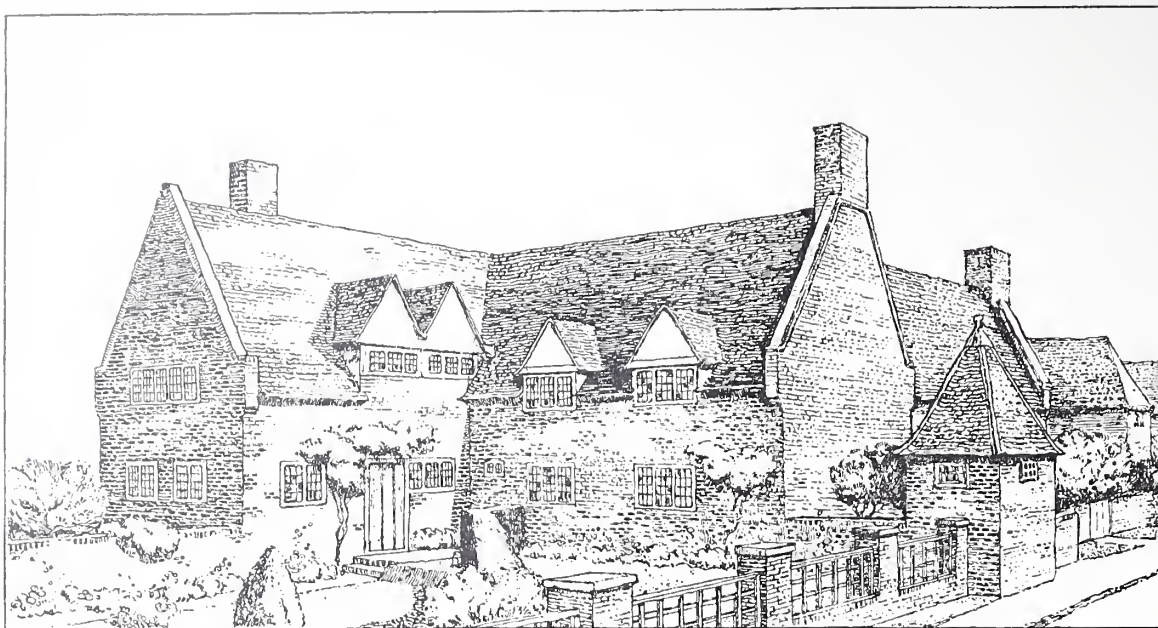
Garden Suburb Hampstead. Gruppenbau mit Gartenpavillon in Hampstead, Architekten: Barry Parker und Raymond Unwin
